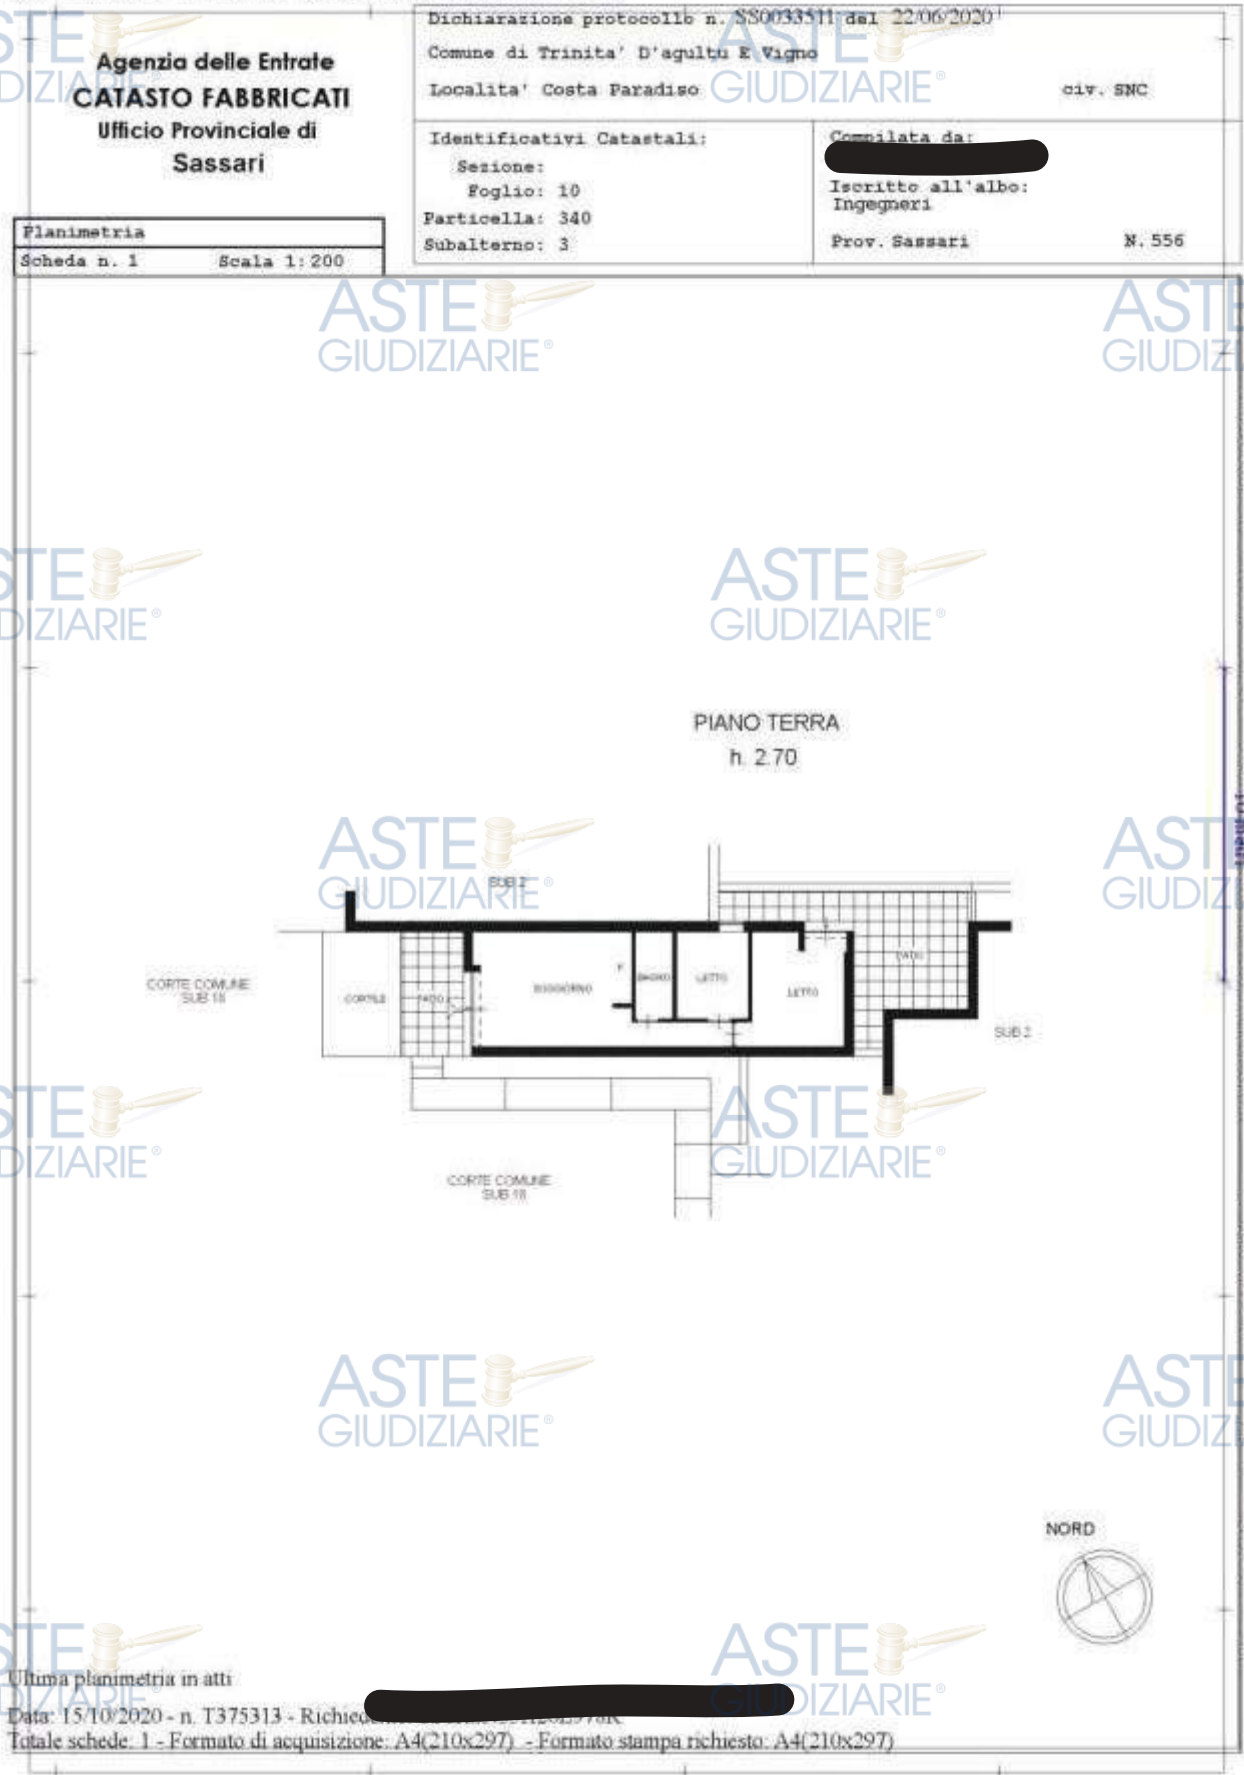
Visura planimetrica catastale aggiornata Fig. 10 Part. 340 Sub 3
